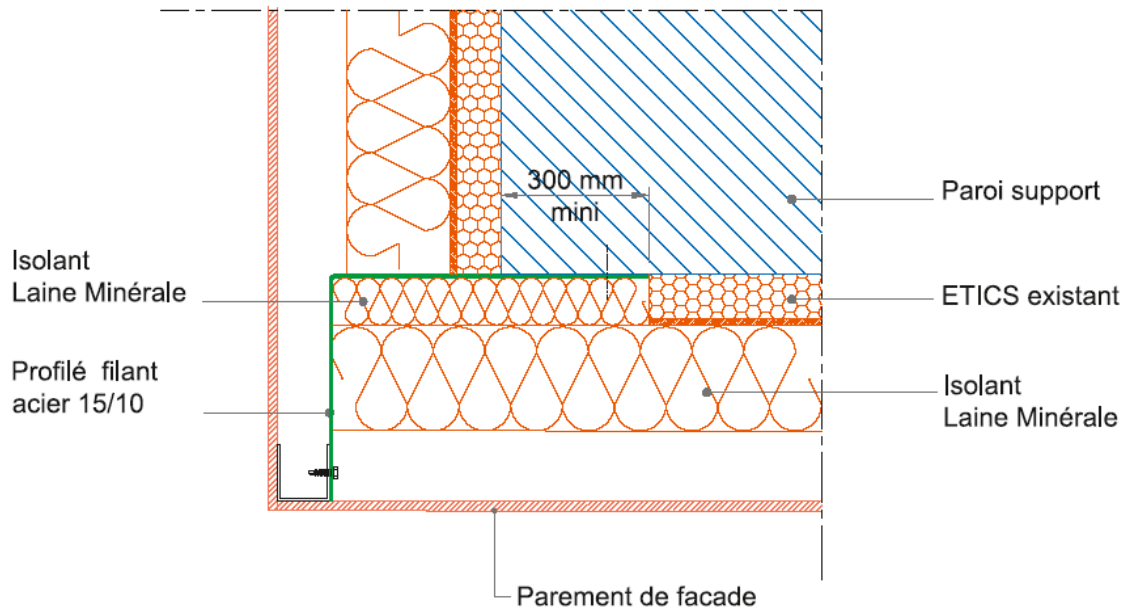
Coupe horizontale du recouplement vertical toute hauteur de la façade
